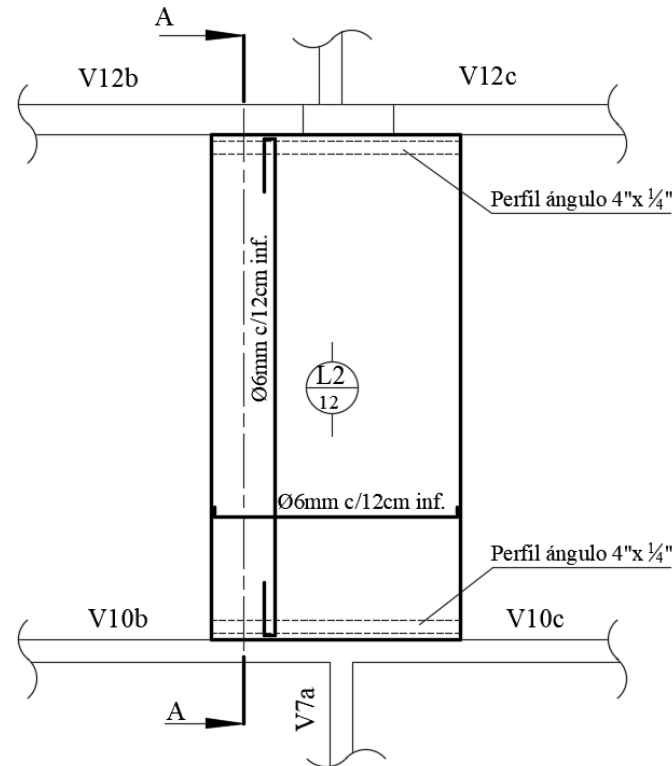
Esquema de planta. Armadura losa nueva L2 baja.
